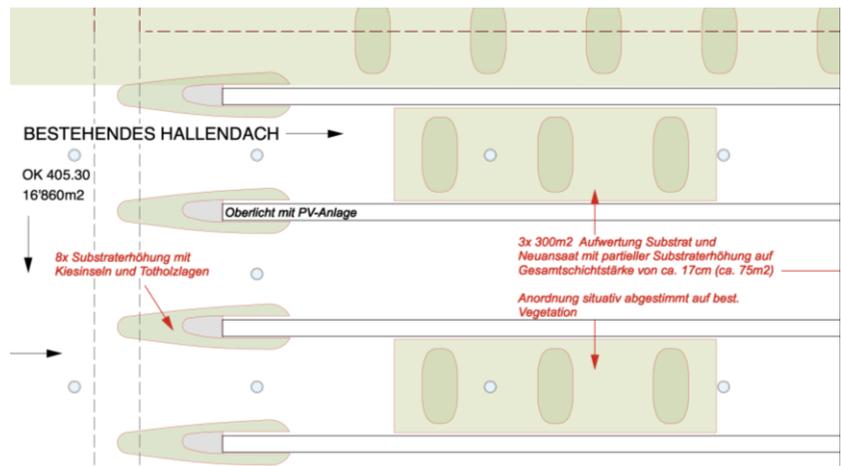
Ausschnitt Baueingabe Plan KOE-720-01 Details Aufbau Gründach
